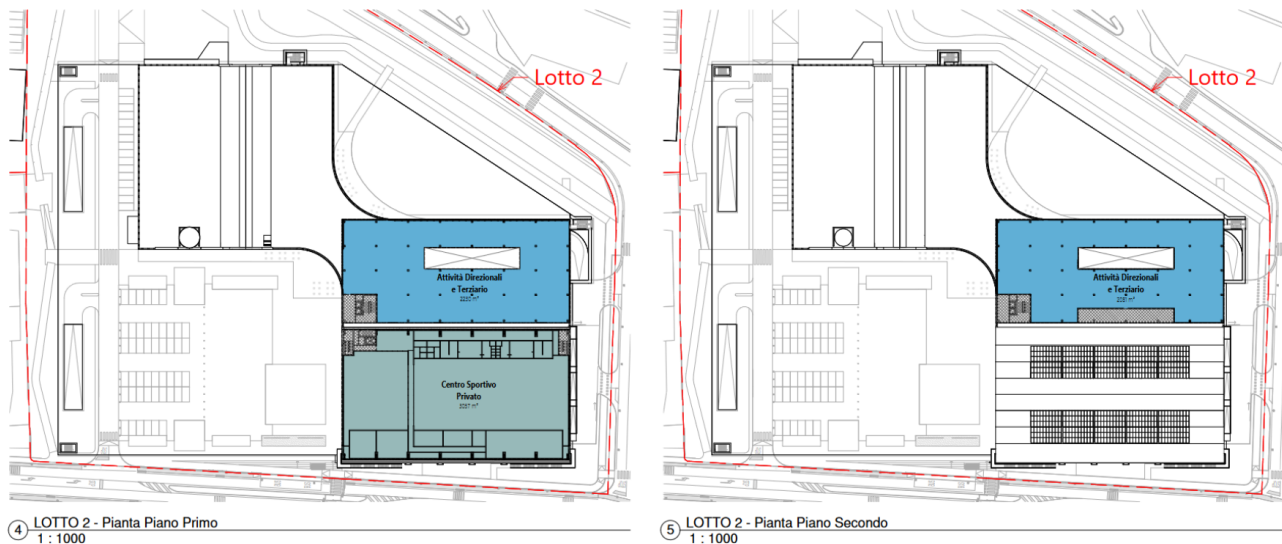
Stralcio piante del complesso multifunzionale - Piano primo e piano secondo
